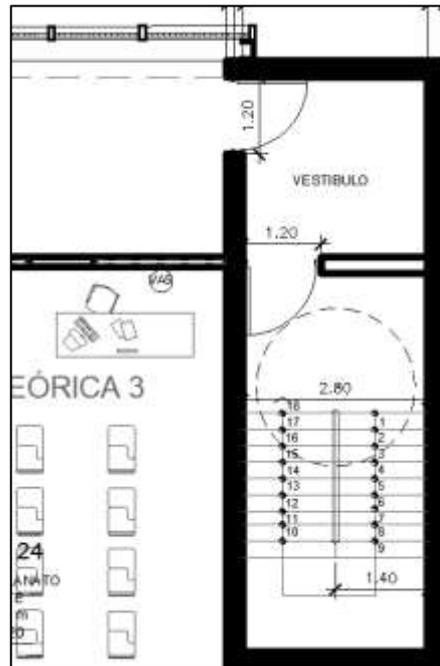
Planta segundo nivel del proyecto-zona educativa- escalera de evacuación.
